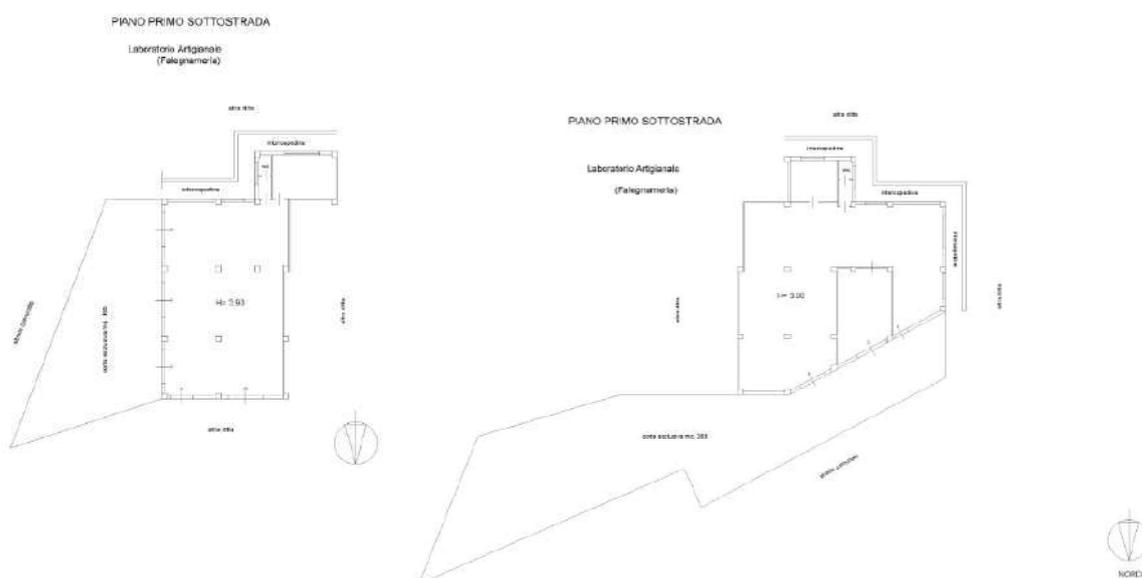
Planimetria u.i.u. Fa. 2, P.IIa 405, Sub 14
